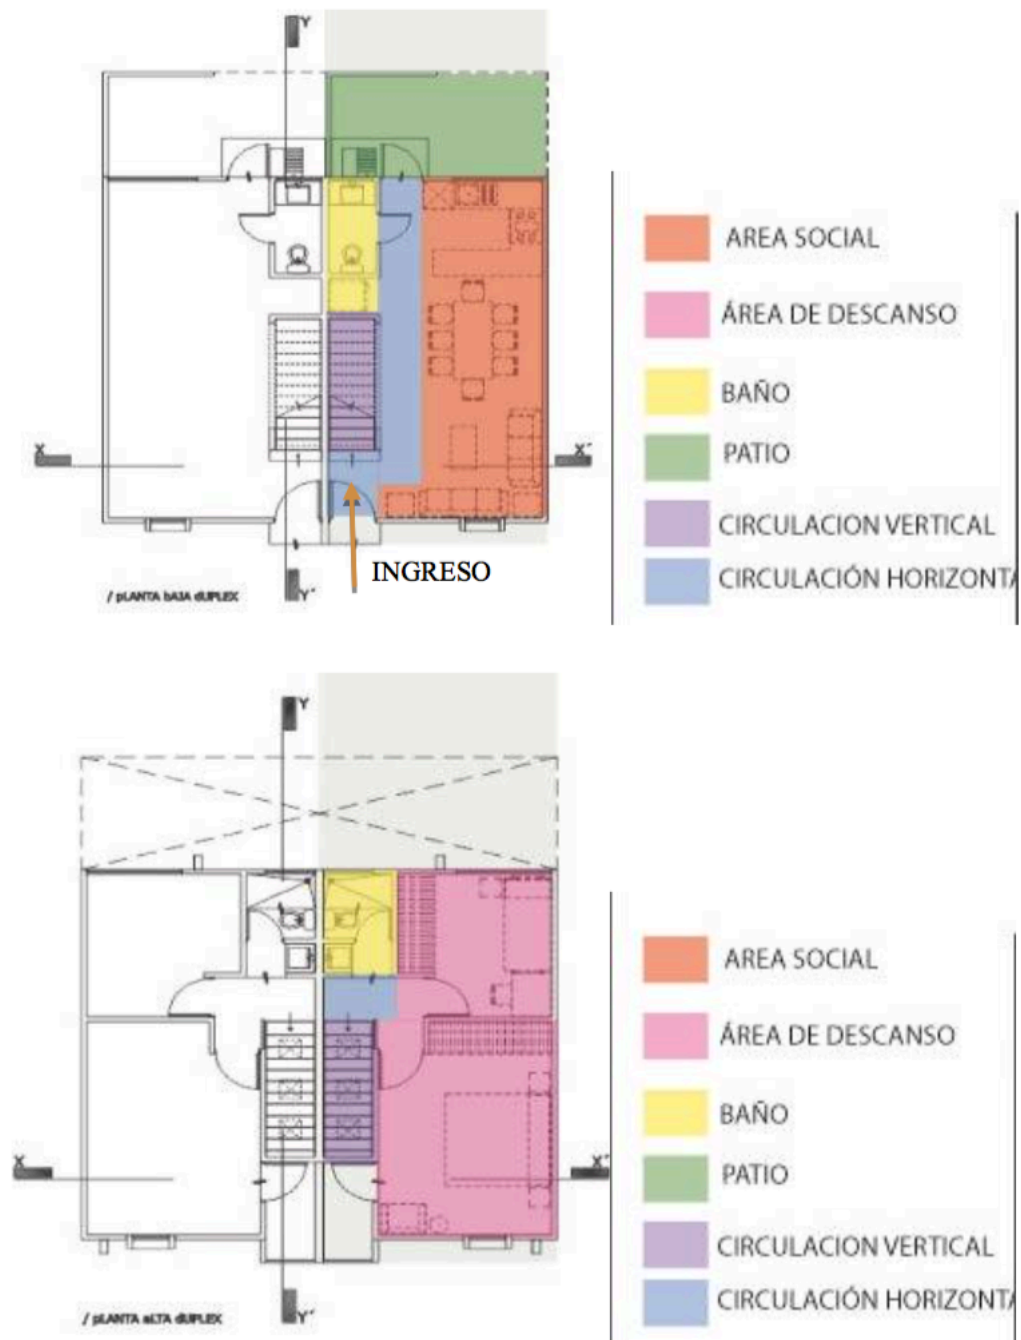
Casa Tipo B – Planta Arquitectónica
